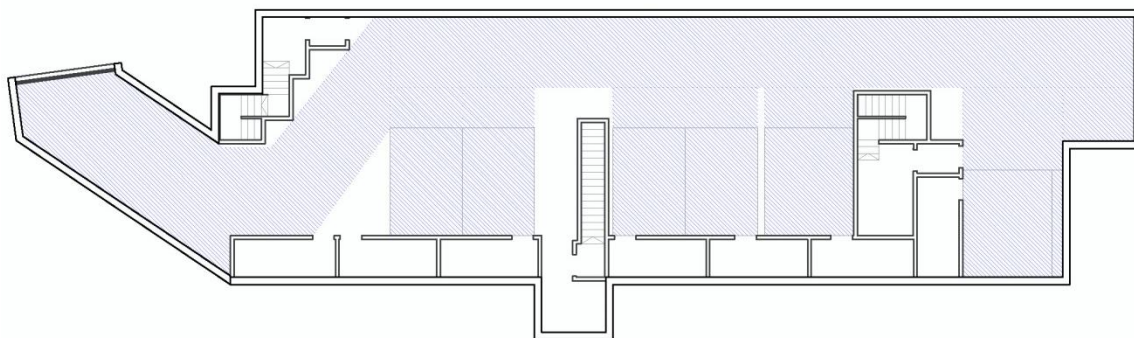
zona libre de pilares por tránsito de vehículos
